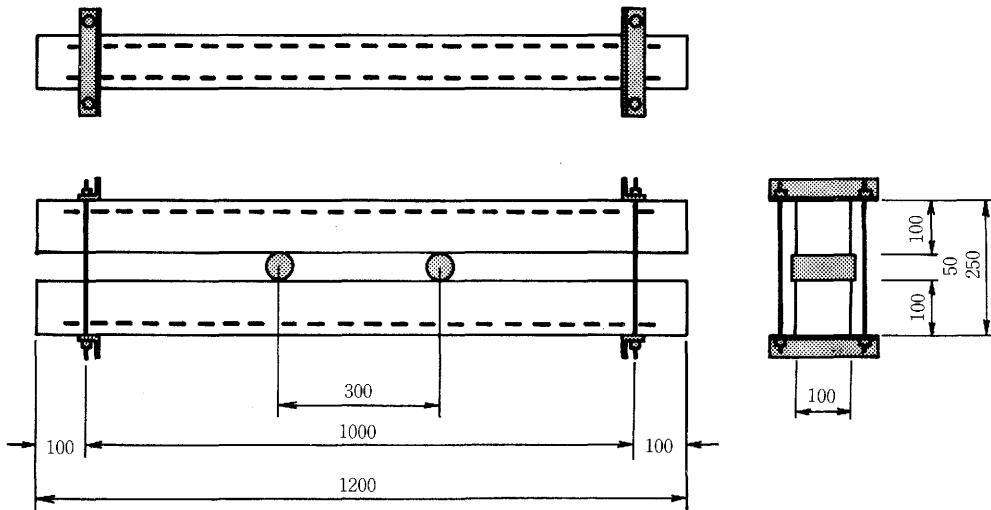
試験体の寸法と導入ひびわれの保持方法 (mm)
